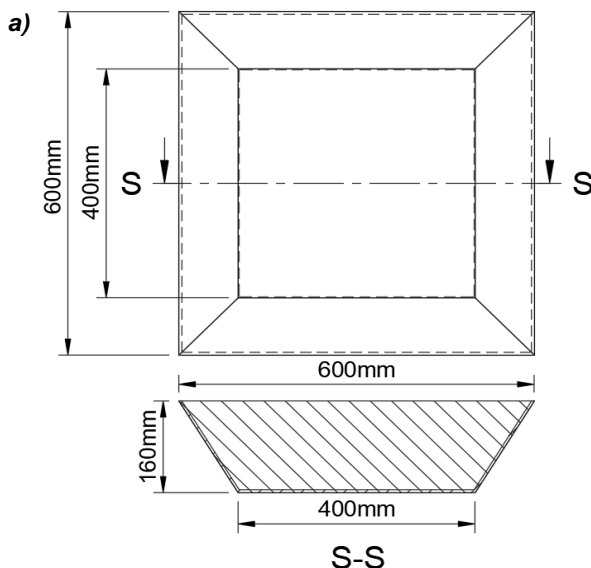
Planejamento seguido para extração dos testemunhos dos painéis projetados.
